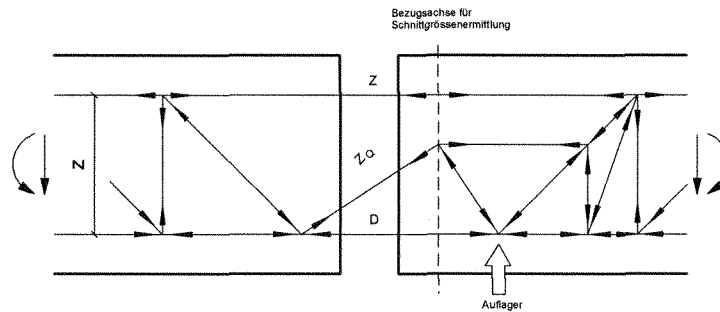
egcobox Kragplattenelement Fachwerkmodell Typ P-F; P-D-F; P-DD-F
